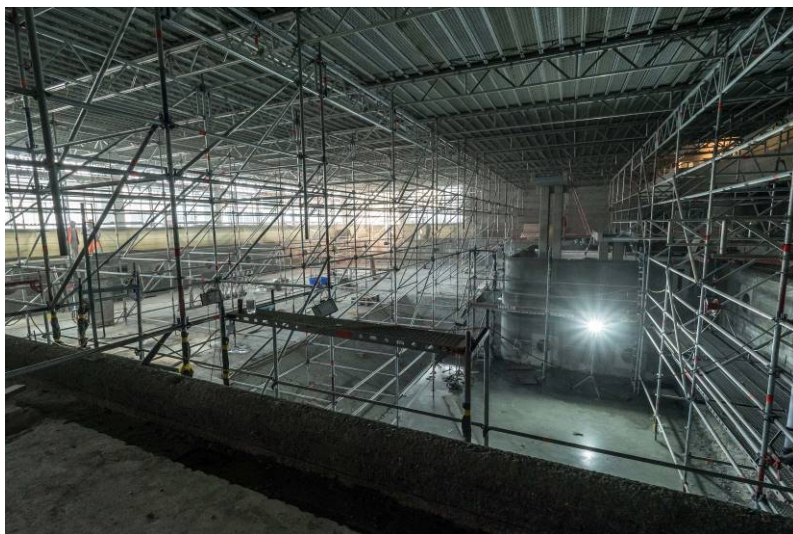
Gerüst im Hallenbad während der Baustelle
